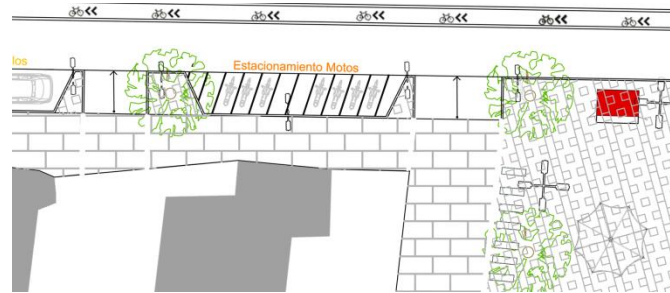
Prueba de diseño, Estacionamientos para motos en la Av. Francisco Solano López.
